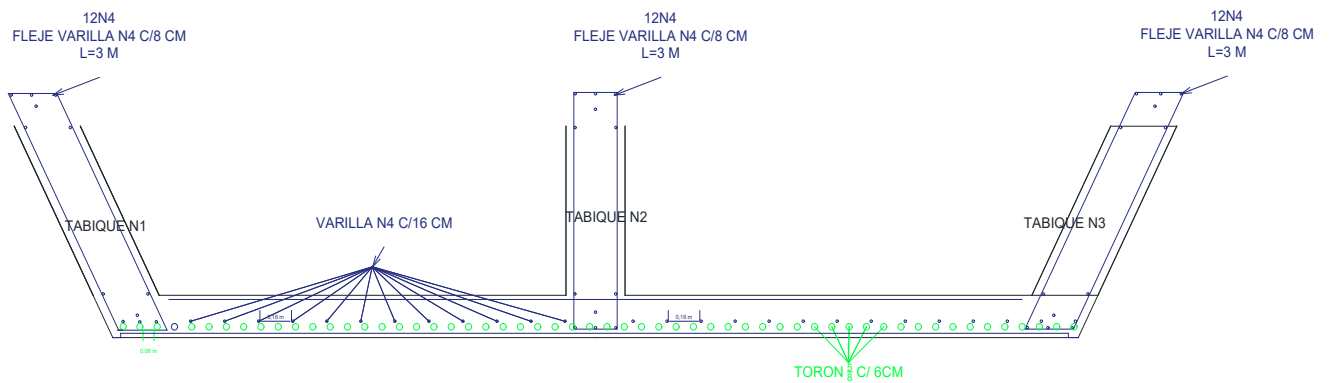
Plano detalle de acero de refuerzo para tabiques de dovela prefabricada de concreto.
